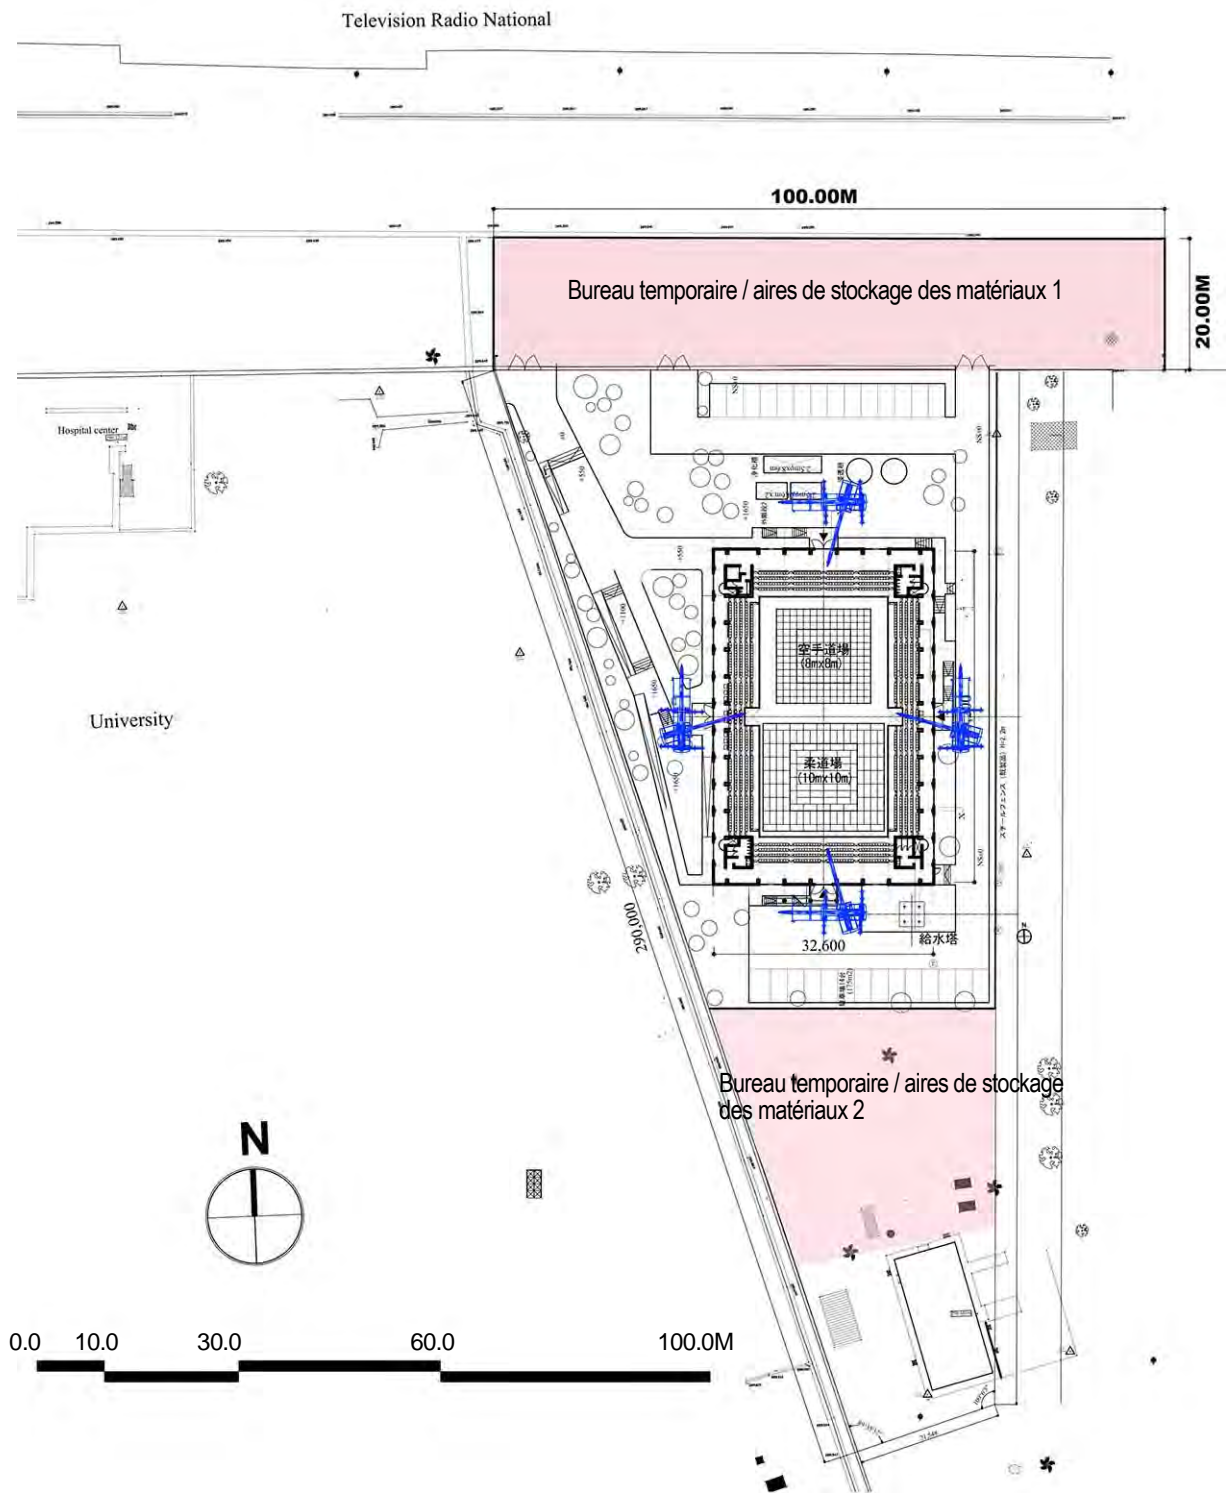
Mise à disposition d'une aire pour les ouvrages temporaires
